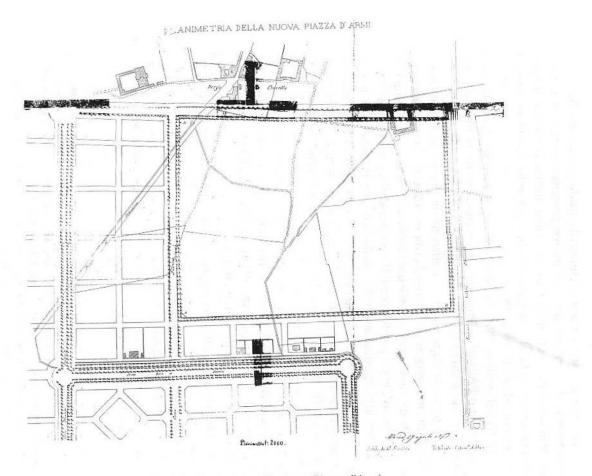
Planimetria della nuova Piazza d'Armi.
